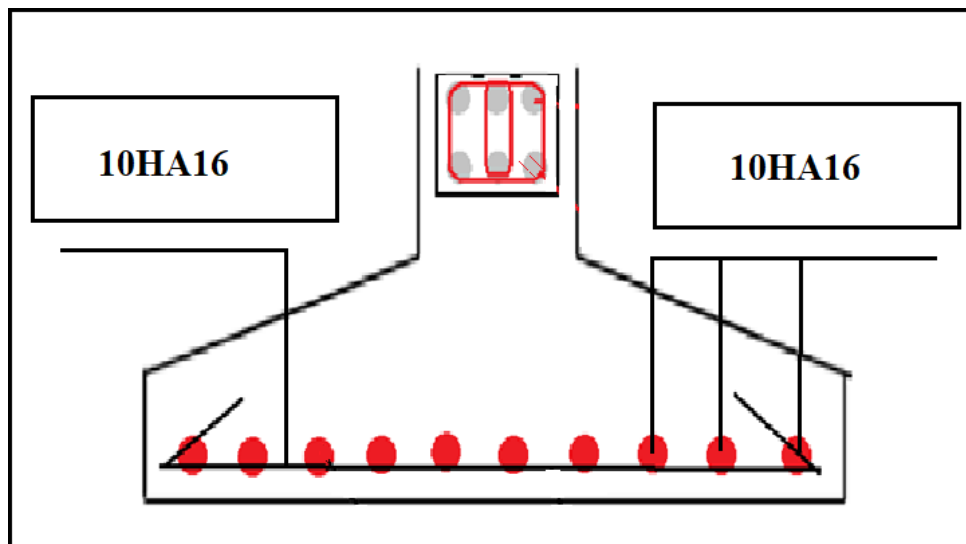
Schéma de ferrailage de la semelle isolée et la Longrine
